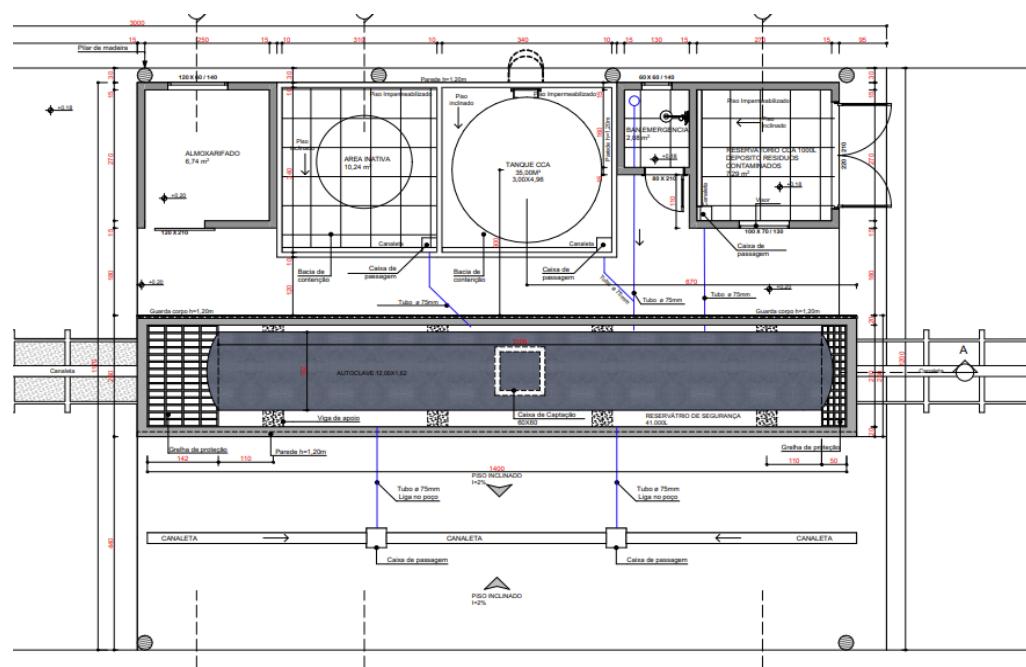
Detalhe da Planta baixa da Usina de Tratamento de Madeira.
